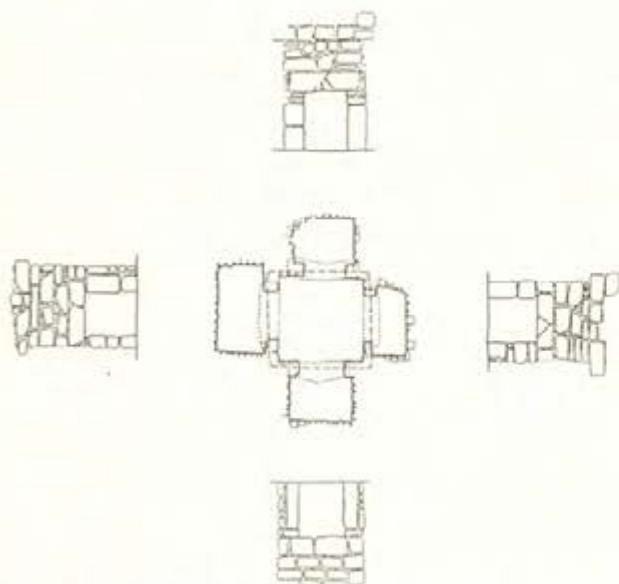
Planta de la Tumba del M-2 y fachadas de las cámaras funerarias, desde el vestíbulo.
